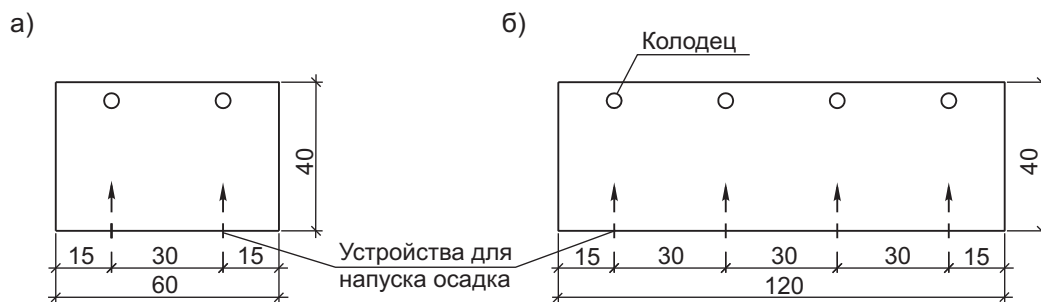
Конструктивные схемы площадок для обезвоживания осадка
